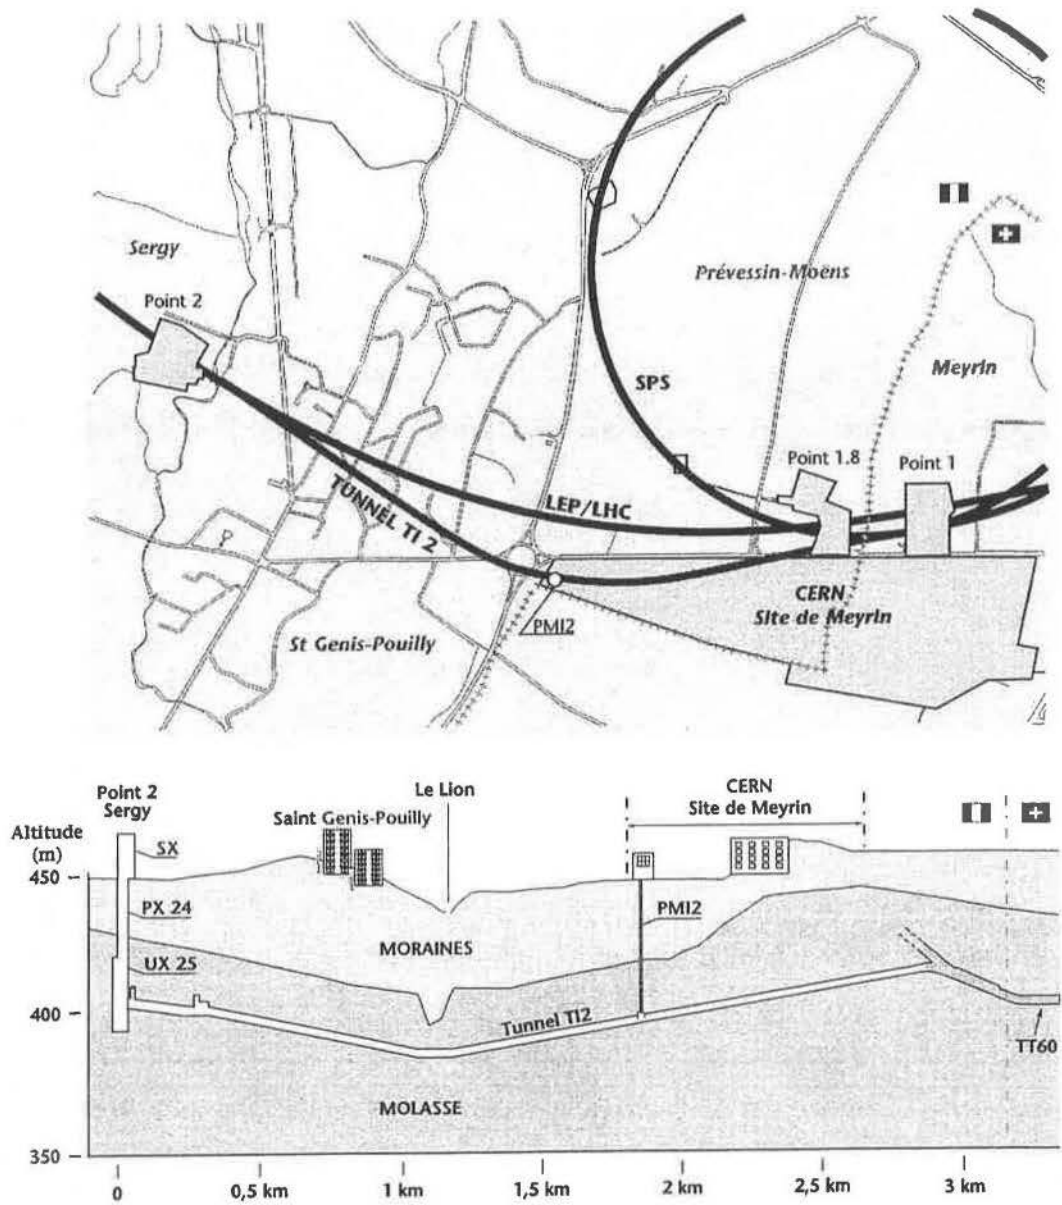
Plan de situation et profil longitudinal du tunnel de transfert T12
